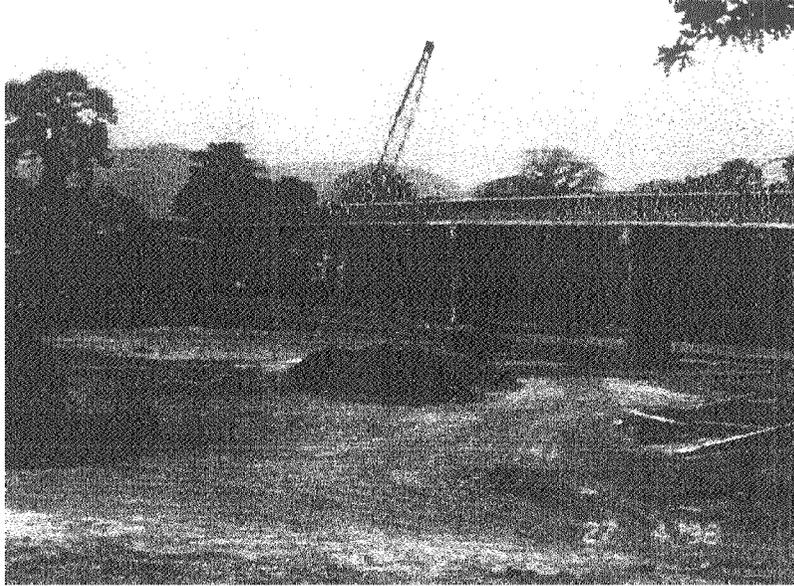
Es preciso tomar en cuenta la existencia de estructuras de ingeniería para la ubicación de bancos de préstamo
